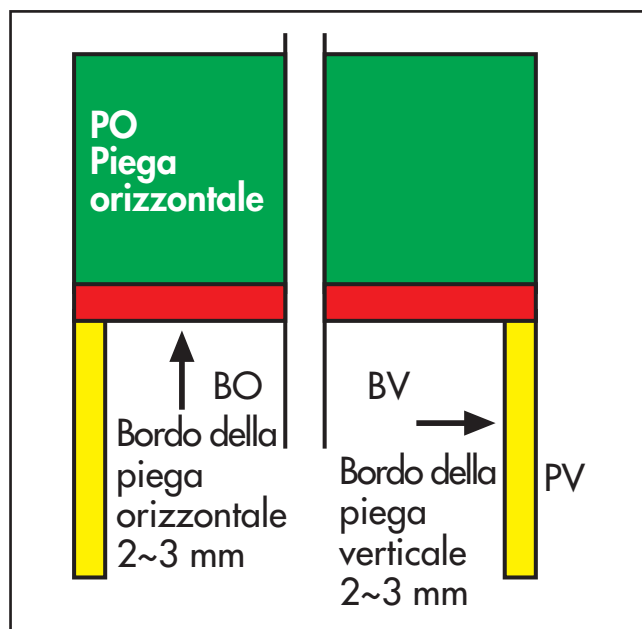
d) - Giunzione a 90° vista dall'alto: prevalenza della piega orizzontale (PV = Piega Verticale)
